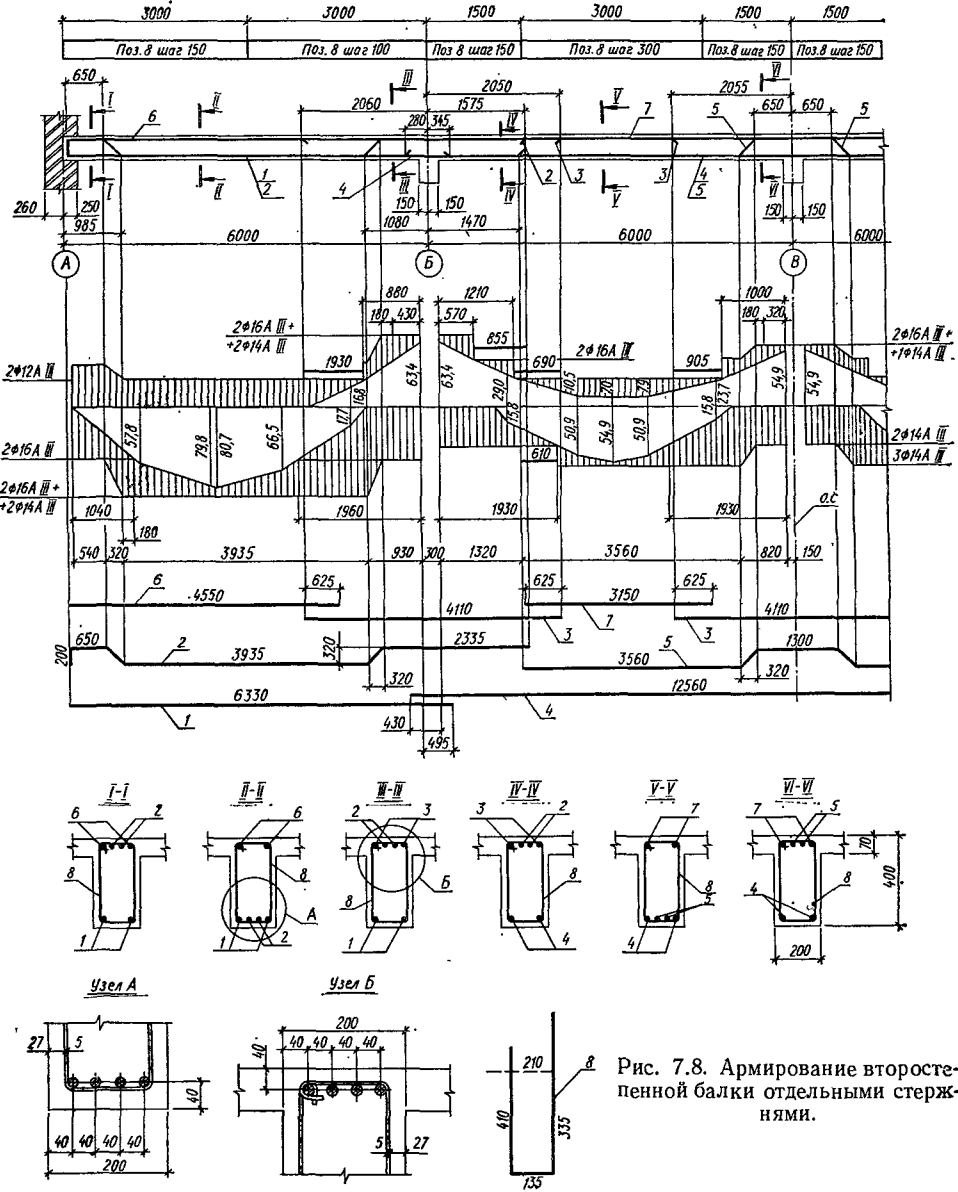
Армирование второстепенной балки отдельными стержнями.
